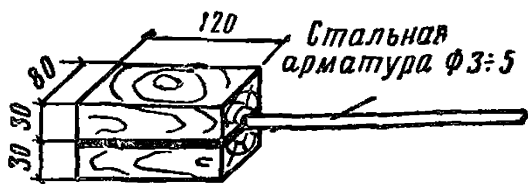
Образец для испытания клеевых соединений древесины со сталью на сдвиг при растяжении
